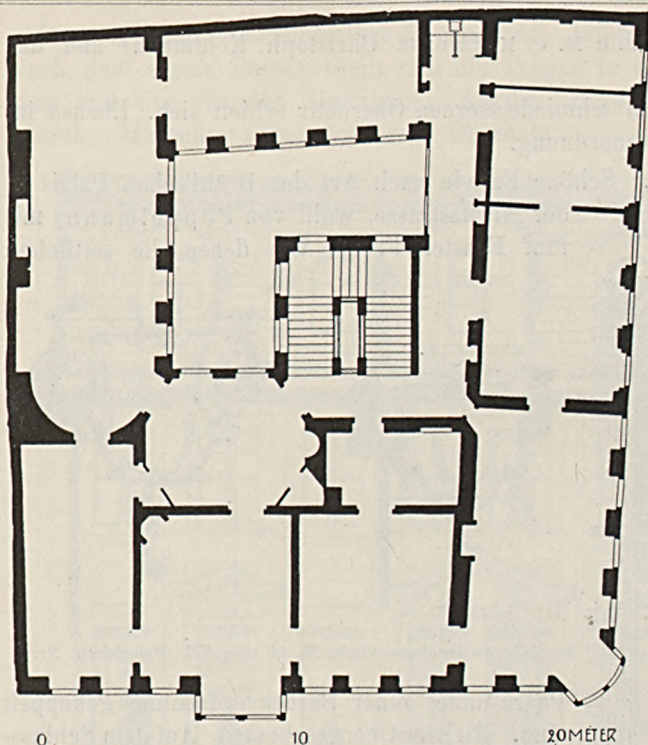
Kleine Brüdergasse Nr. 21. Grundriss des Obergeschosses.
